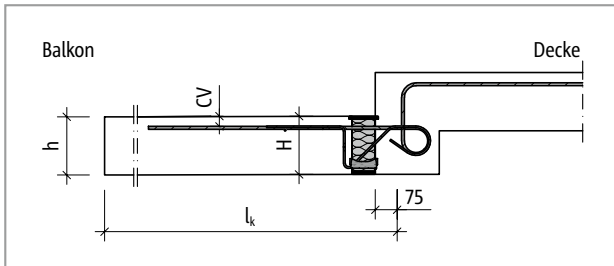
Schöck Isokorb® T Typ K-HV: Statisches System
